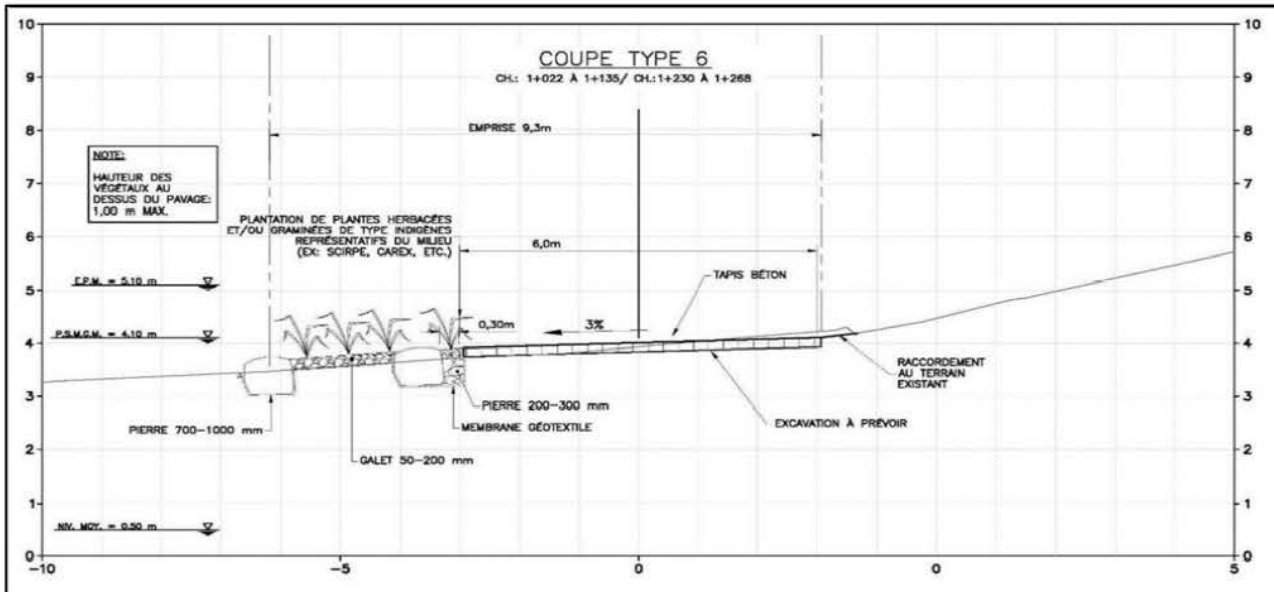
Coupe-type secteur C (coupe-type 6)
